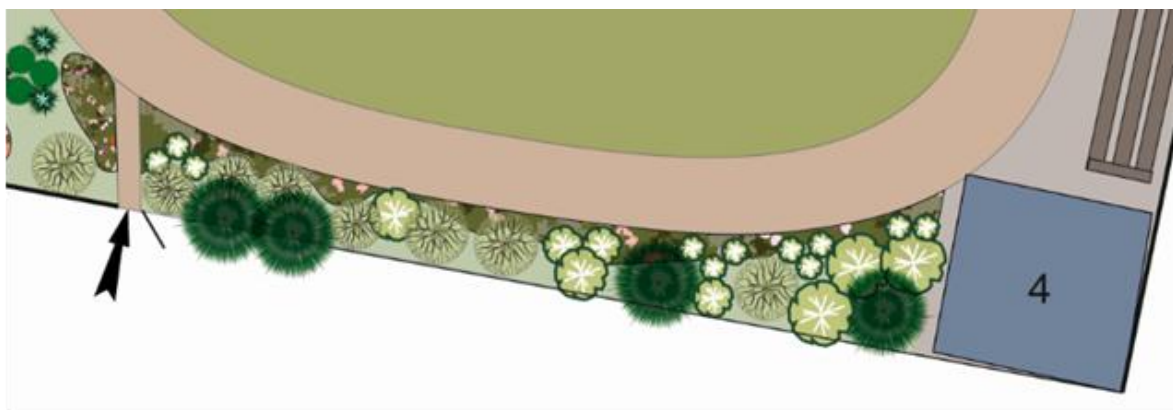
План расположения насаждений вдоль южной границы
